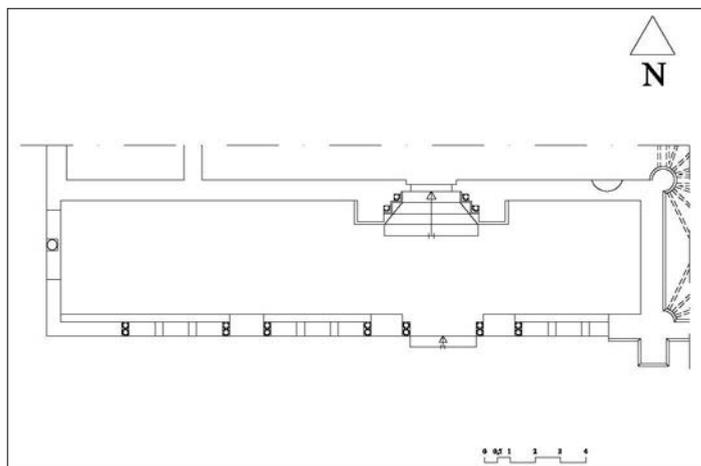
Planta del pórtico de Beña de Sorbe (Guadalajara). Plano: autor y Roberto Escalonilla
